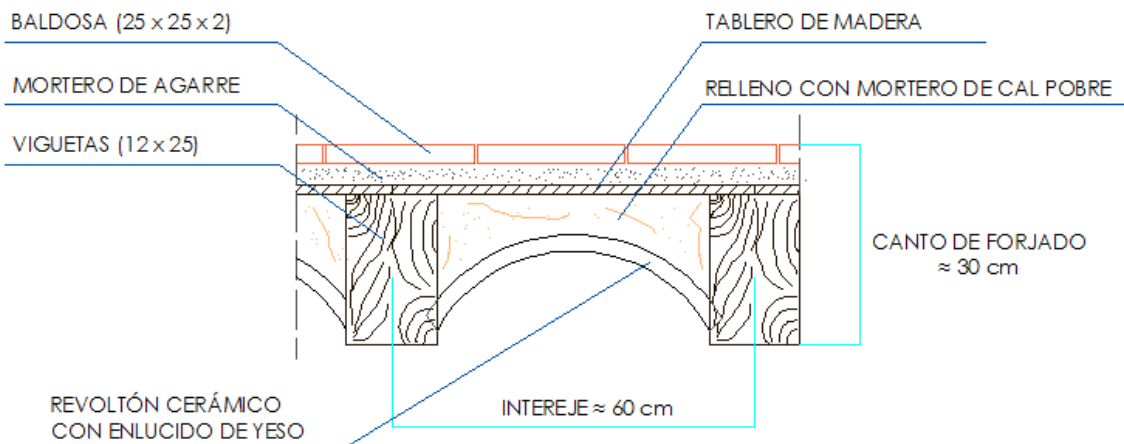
Detalle constructivo de las viguetas del forjado (hipotético)
